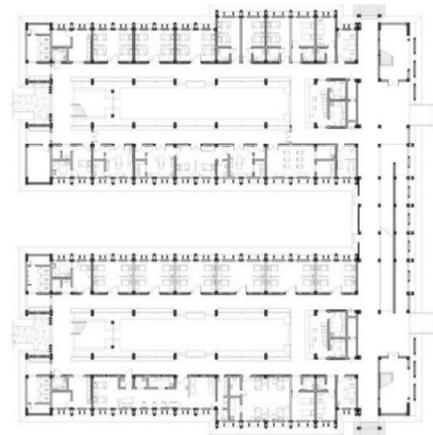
Plan du rez-de-chaussée du bâtiment des patients hospitalisés, Source : Archdaily
